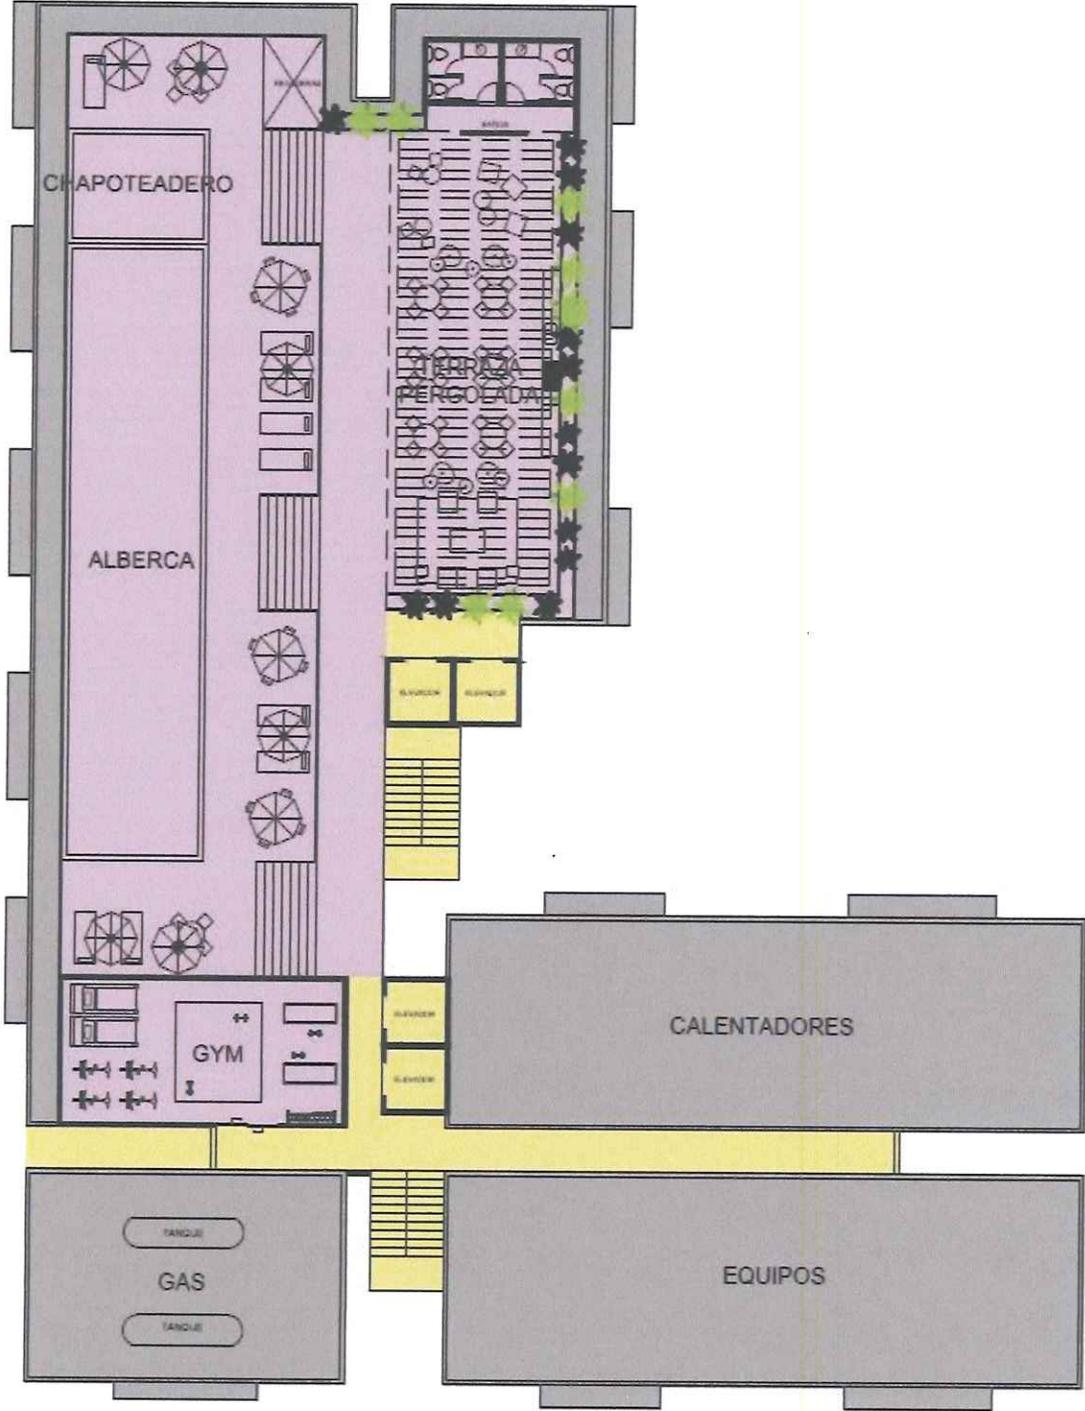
Plano nivel azotea. Fuente: Plano Arquitectónico.
